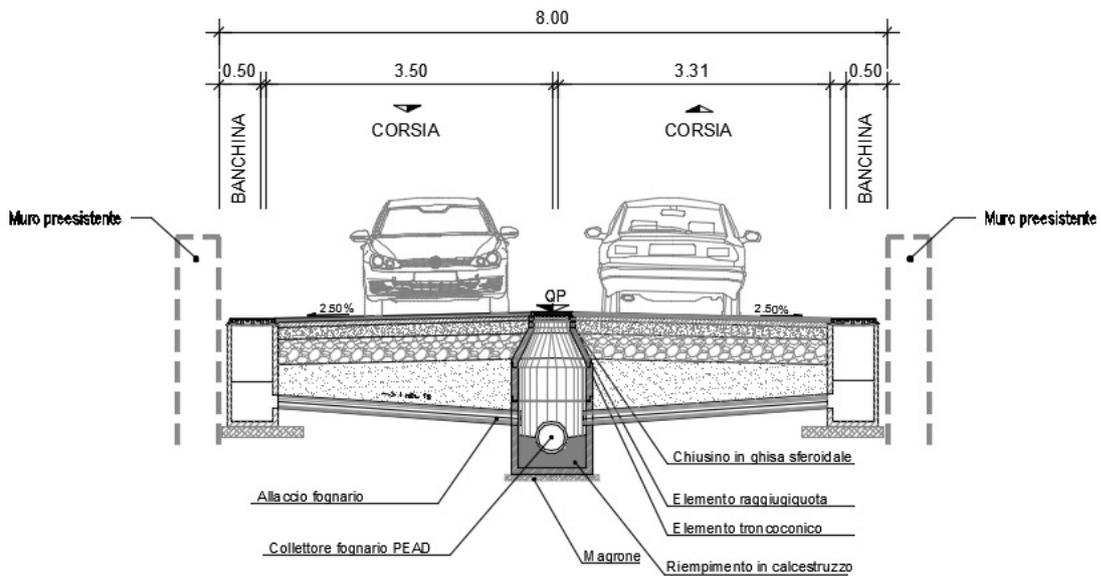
Sezione viabilità proveniente da cavalcavia preesistente
